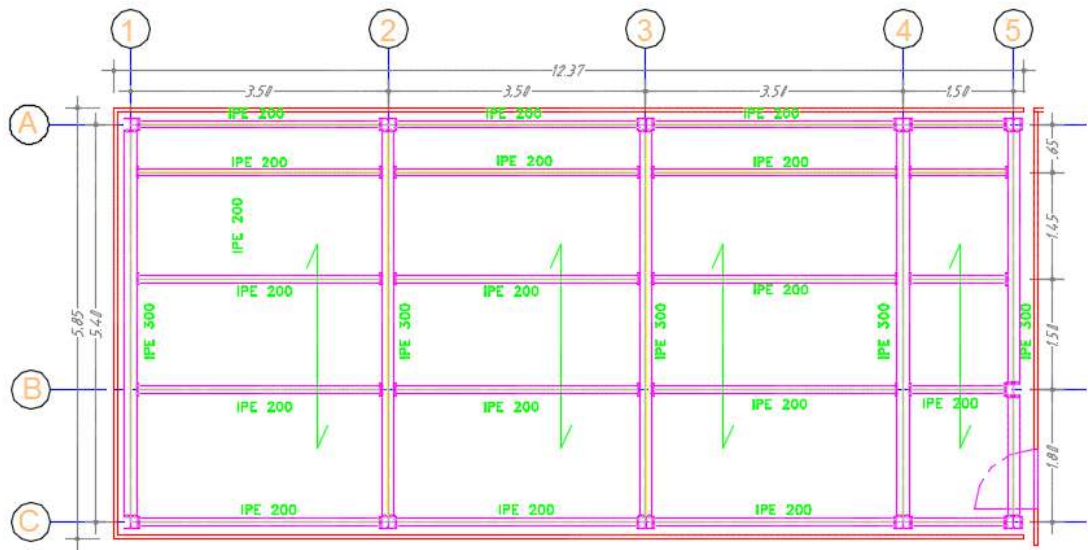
Vue en plan des planchers Niveau : +3.20 et +7.20
